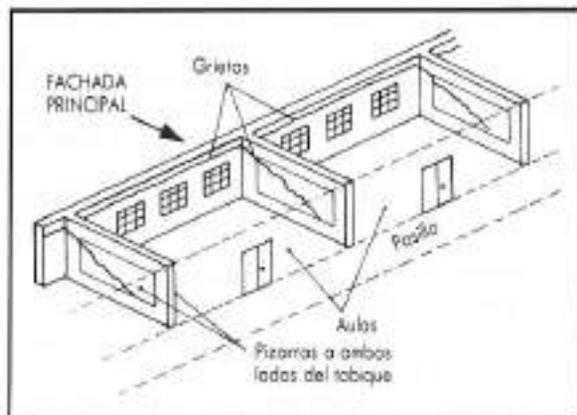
Disposición de las grietas en las aulas de la fachada principal.
